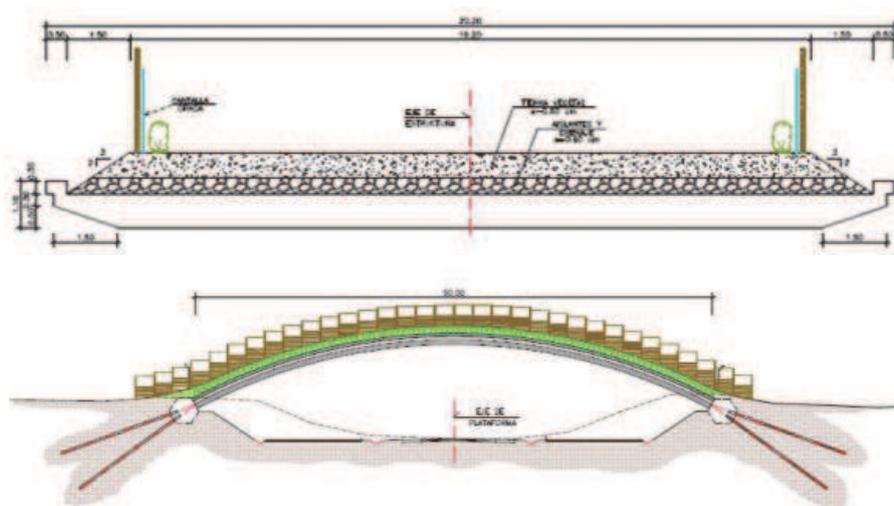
Secciones longitudinal y transversal de un paso superior. Fuente: Proyecto de Construcción: Pasos de fauna en A-483 y A-494. Junta de Andalucía (2008).
